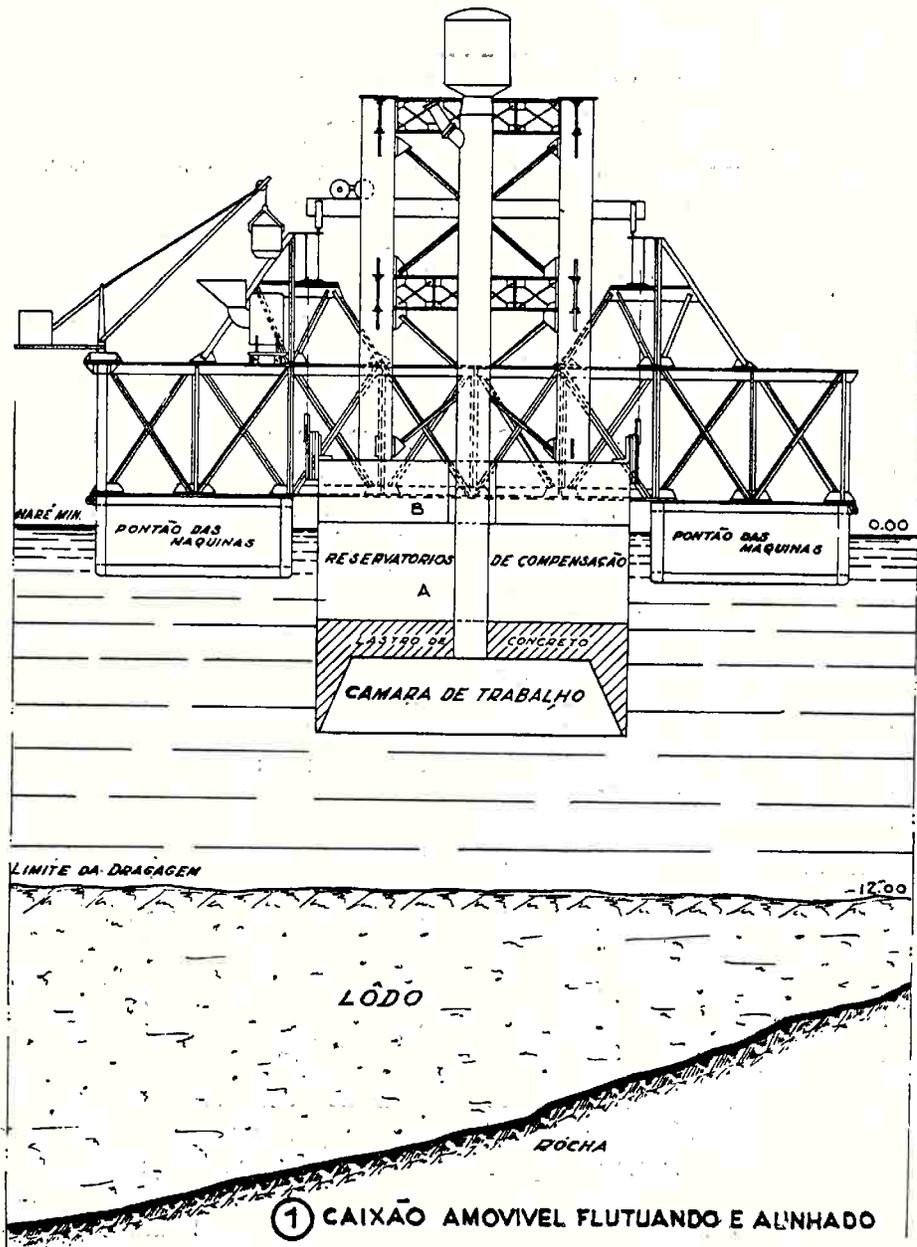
Fases sucessivas da construção pneumática dos pilares do segundo trecho do cais do porto do Rio de Janeiro — 1924-1929.
